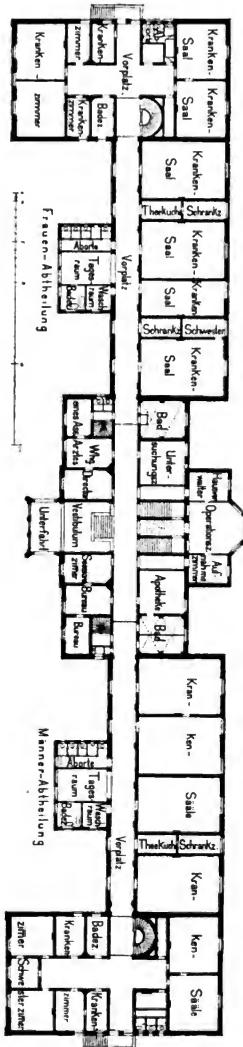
u. 331. Ansicht und Grundriß des Sickenhauses.
